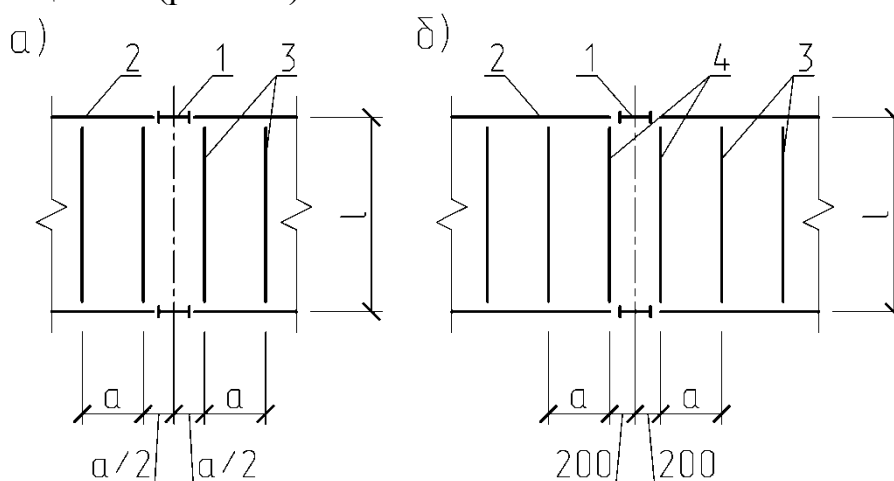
Размещение балок настила при установке главных балок на колонны сверху:
